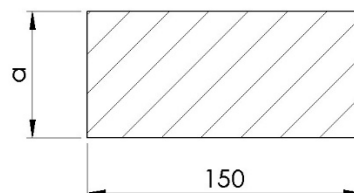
Sección rectangular de la viga central en mm (Fuente: propia)
